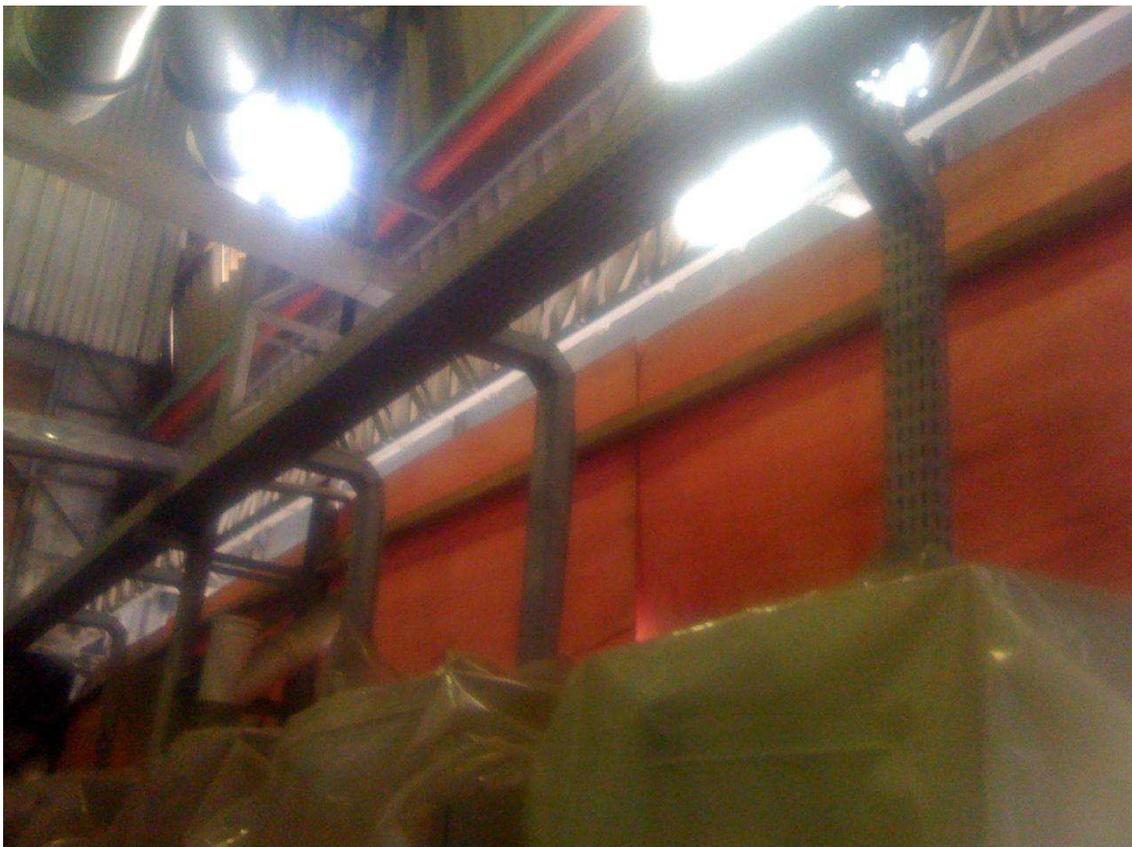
Foto da estrutura para alimentação de uma estufa do modelo 1.
